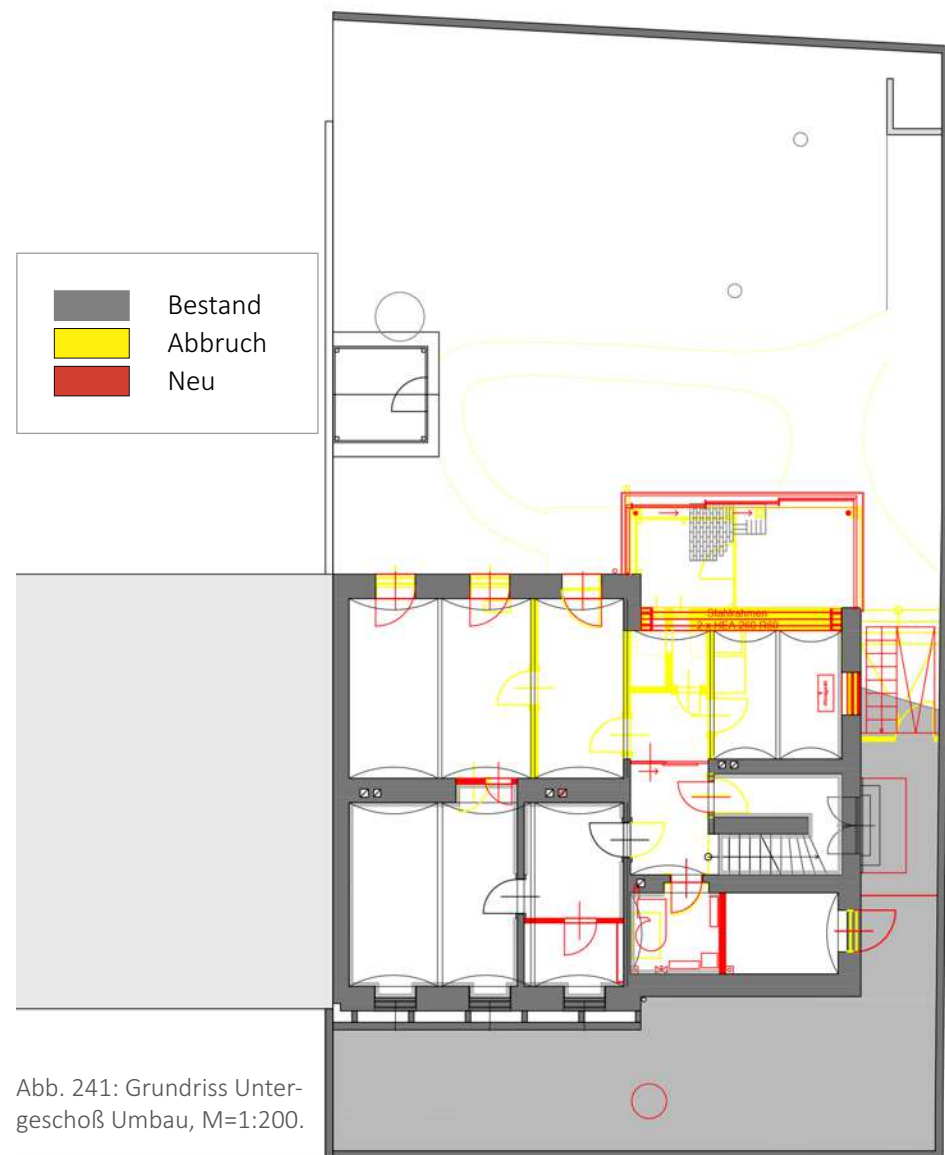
Grundriss Untergeschoß Umbau, M=1:200.
